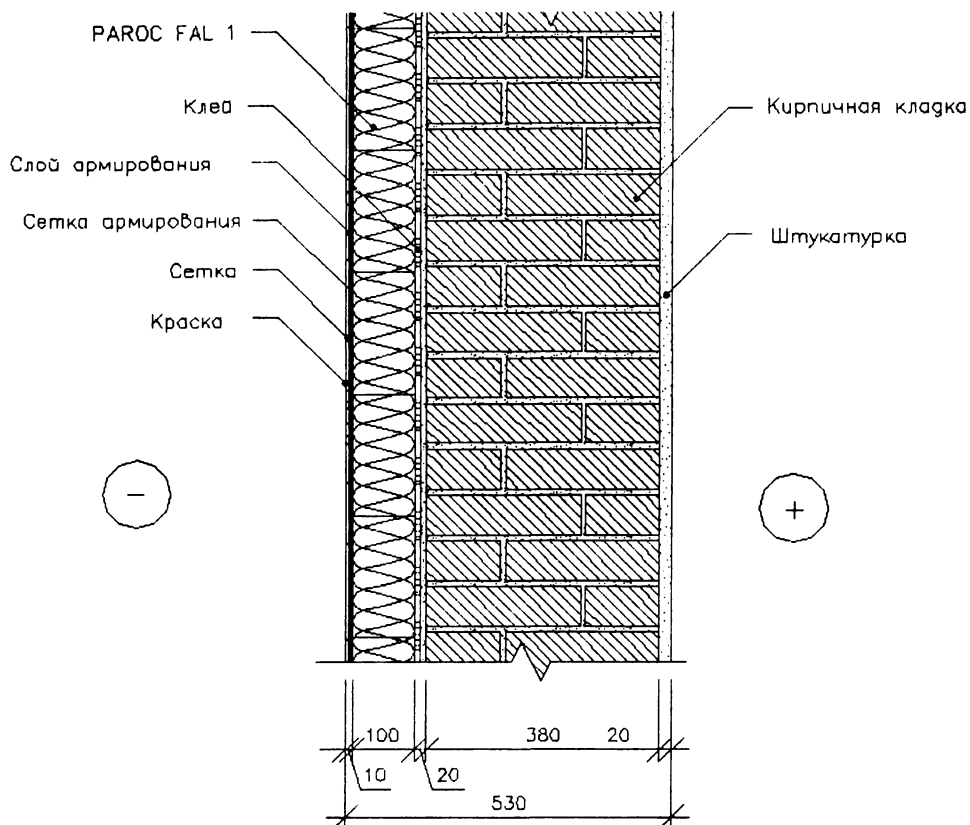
Утепление стены кирпичной кладки, применяя для системы фасадную плиту PAROC FAL 1
